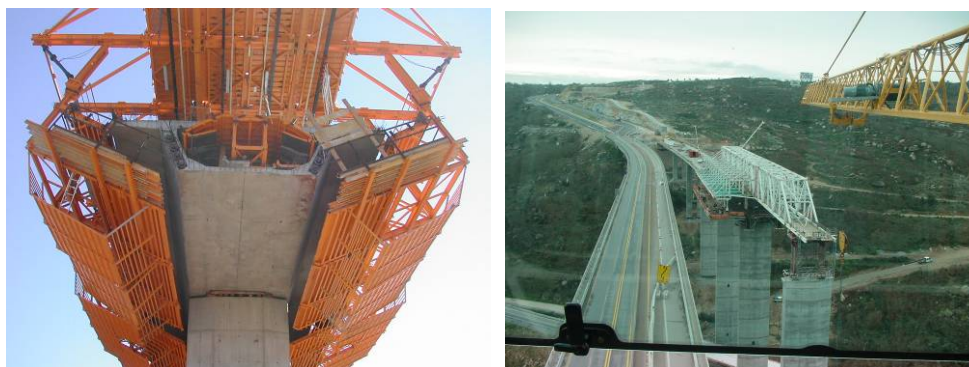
e 7 – Pilar de viaduto em caixão(esq) e de 100m de altura - secção em Π (dir)
